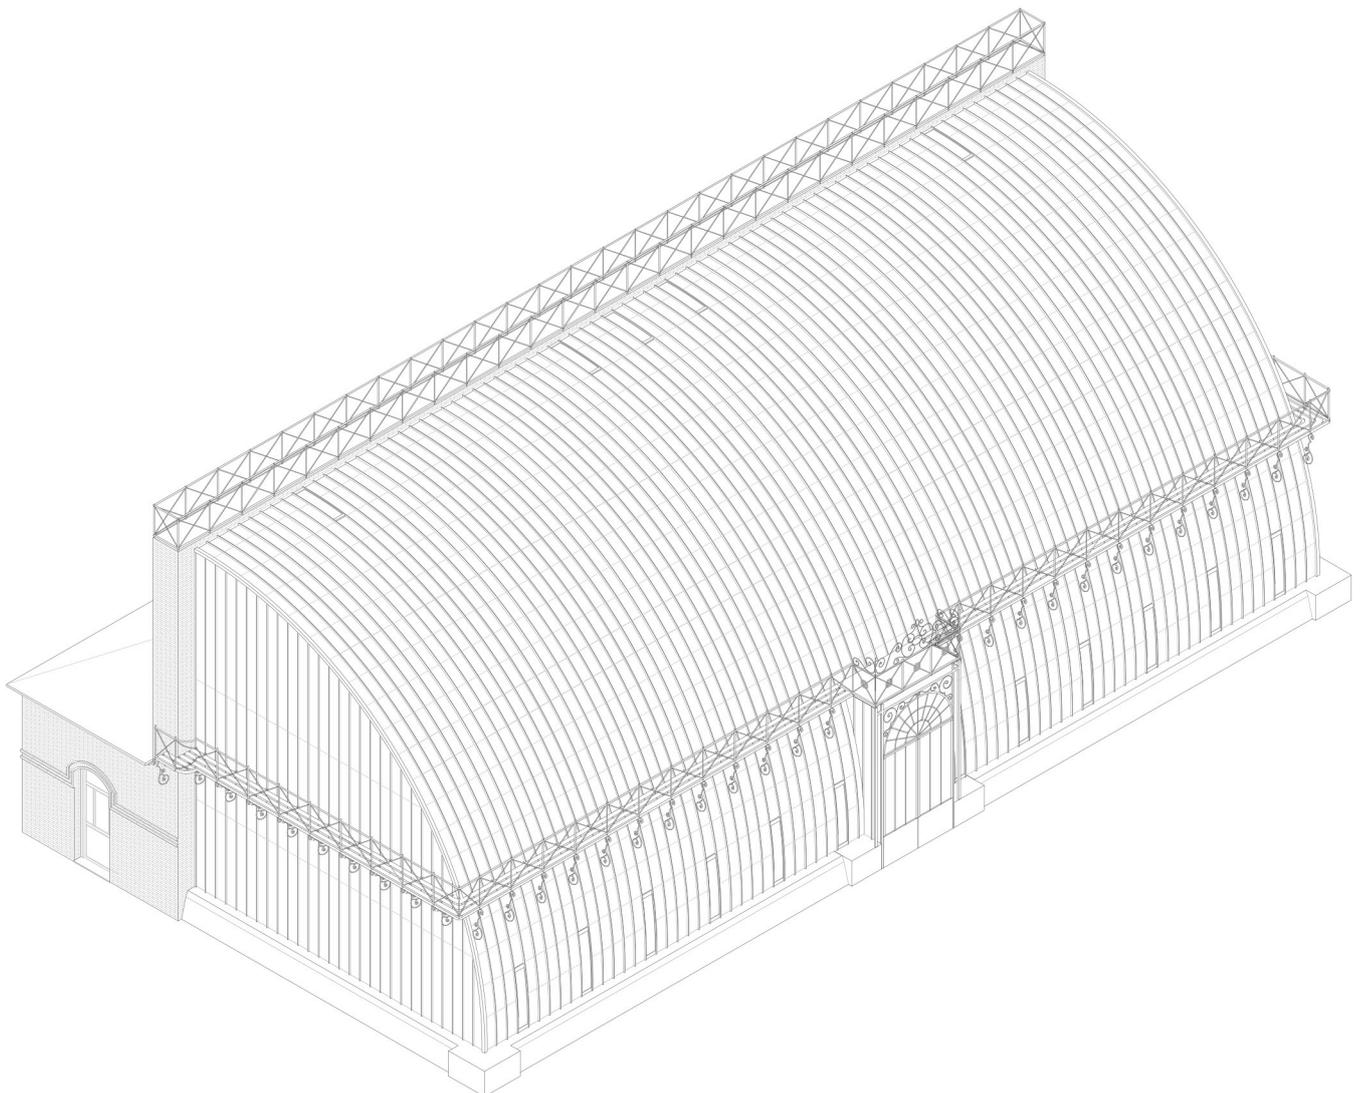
Axonometría de la Estufa Tropical según el proyecto original. Elaborado por la autora.
